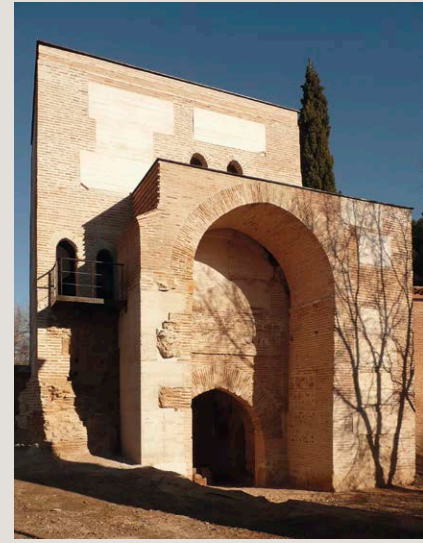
Imagen final de la Puerta de Burgos restaurada (Depto. Arquitectura, Obispado Alcalá de Henares)
